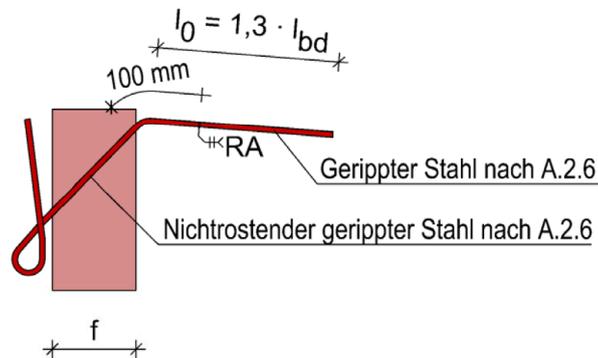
Querkraftstabvariante 2 – Schlaufe stumpfgeschweißt
